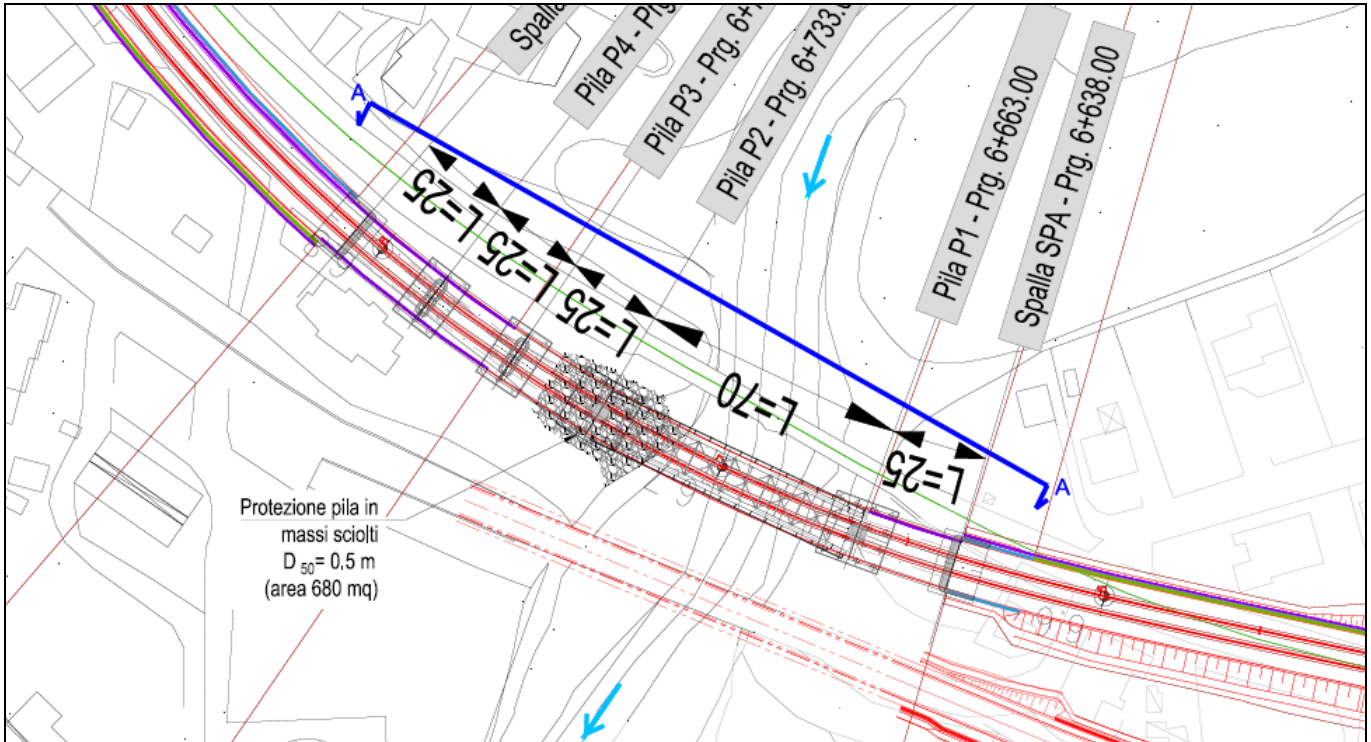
Viadotto VI23: opere di protezione previste in corrispondenza delle pile interessate dalla piena di progetto.
